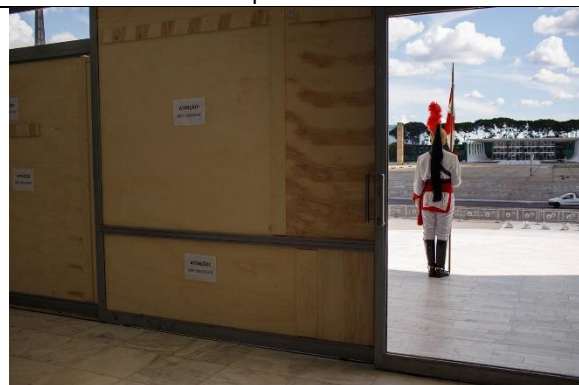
Fachada envidraçada do 2º pavimento provisoriamente vedada com tapumes. A substituição está prevista
